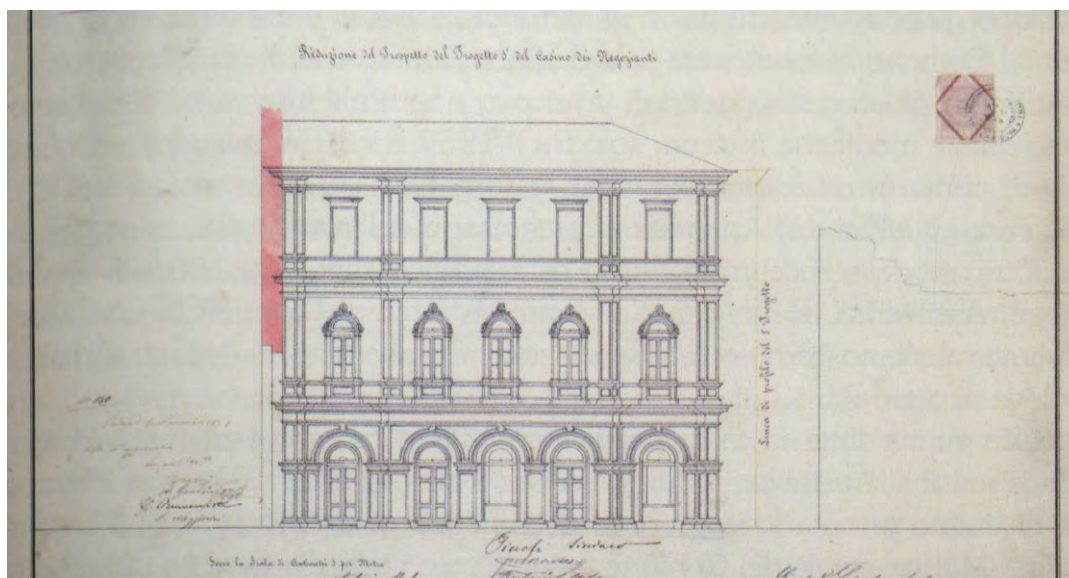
Giuseppe Selvelli, *Progetto per il Casino dei Negozianti, Prospetto della facciata, 1873
